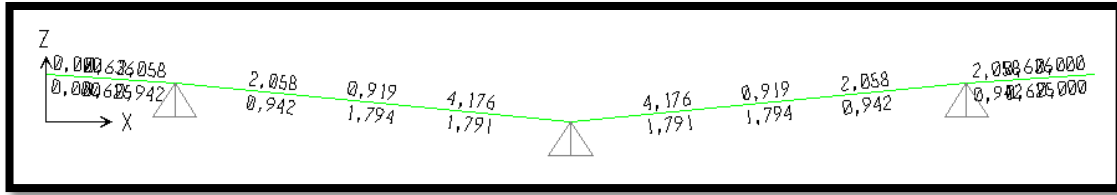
As en cm^2 por nervio de losa de techo. Elaborado con el Software de Cálculo SAP 2000.
